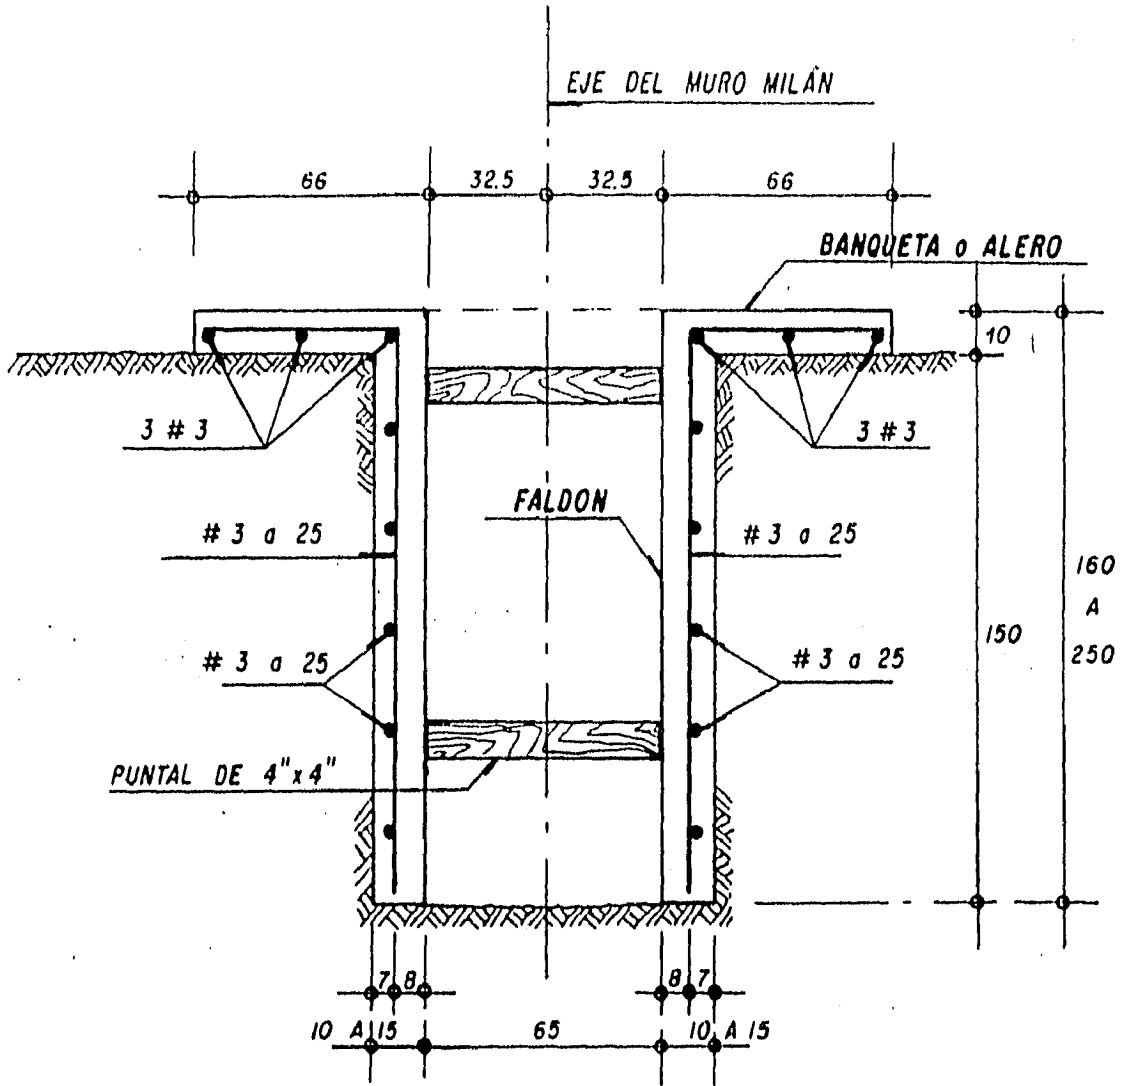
PREECAVACIÓN PARA LA CONSTRUCCIÓN DEL BROCAL GUÍA.
